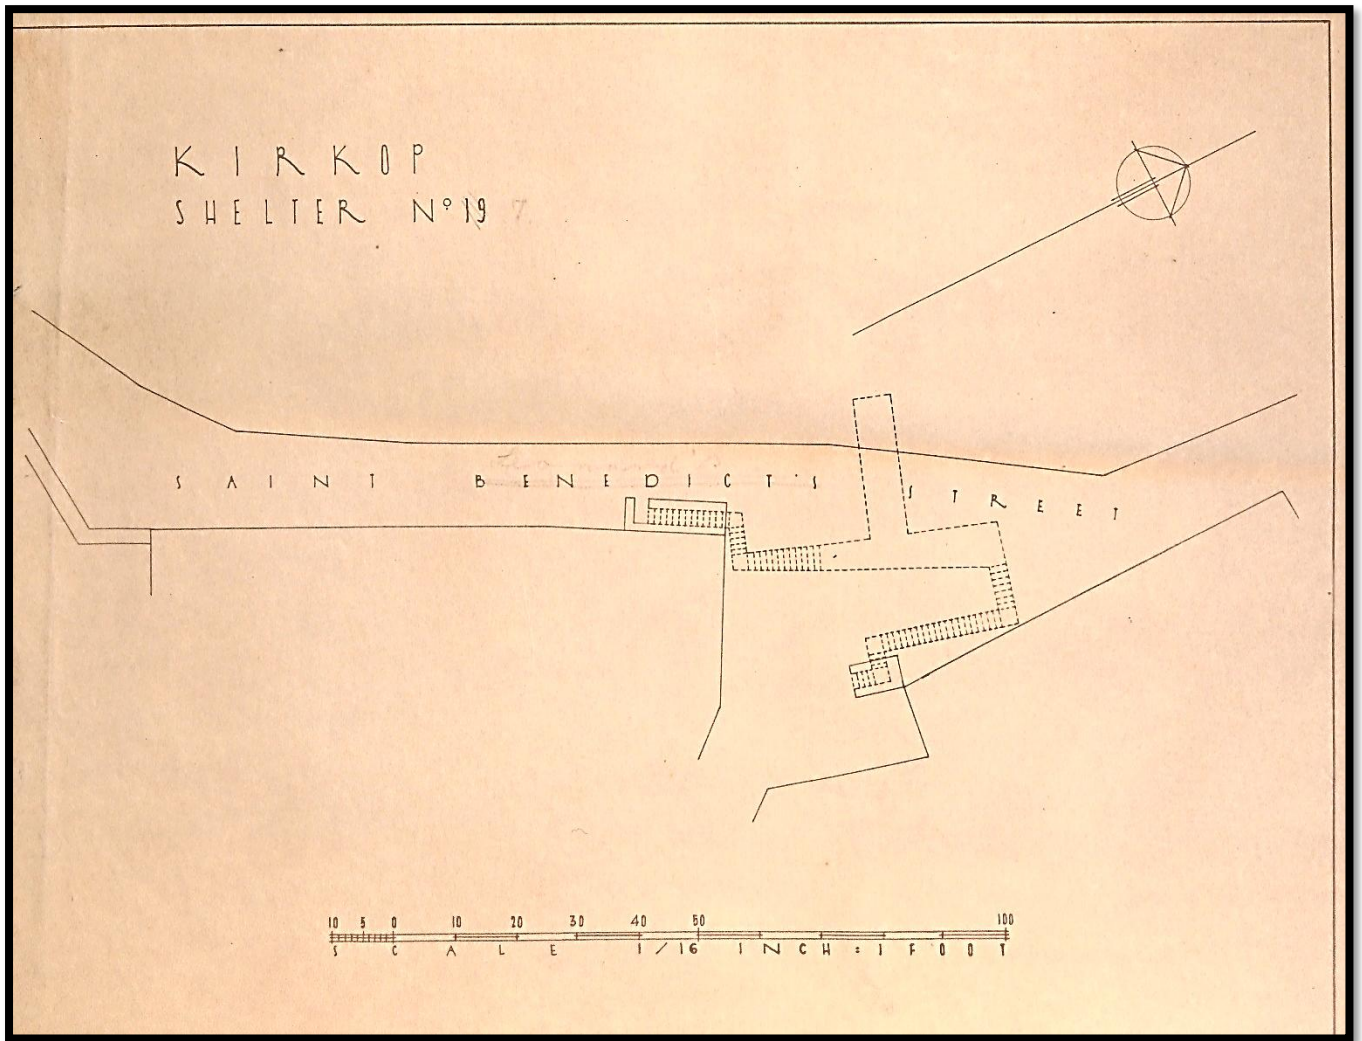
Planta do Abrigo nº19 (7) "Saint Benedict's Street."
